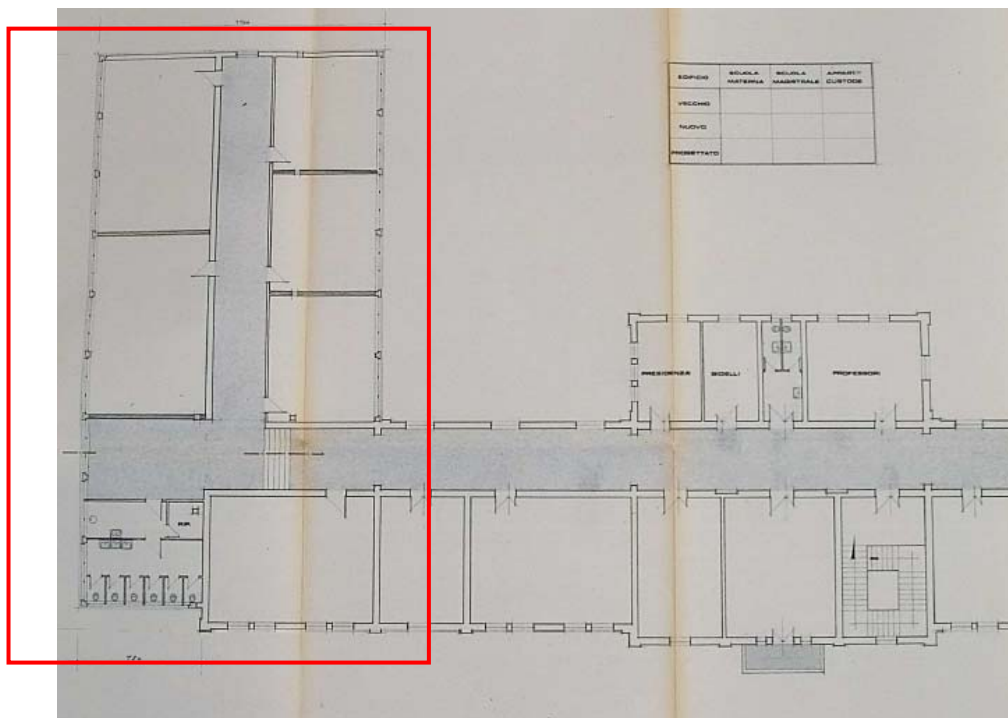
Piano primo – ampliamento/sopraelevazione Blocco B
